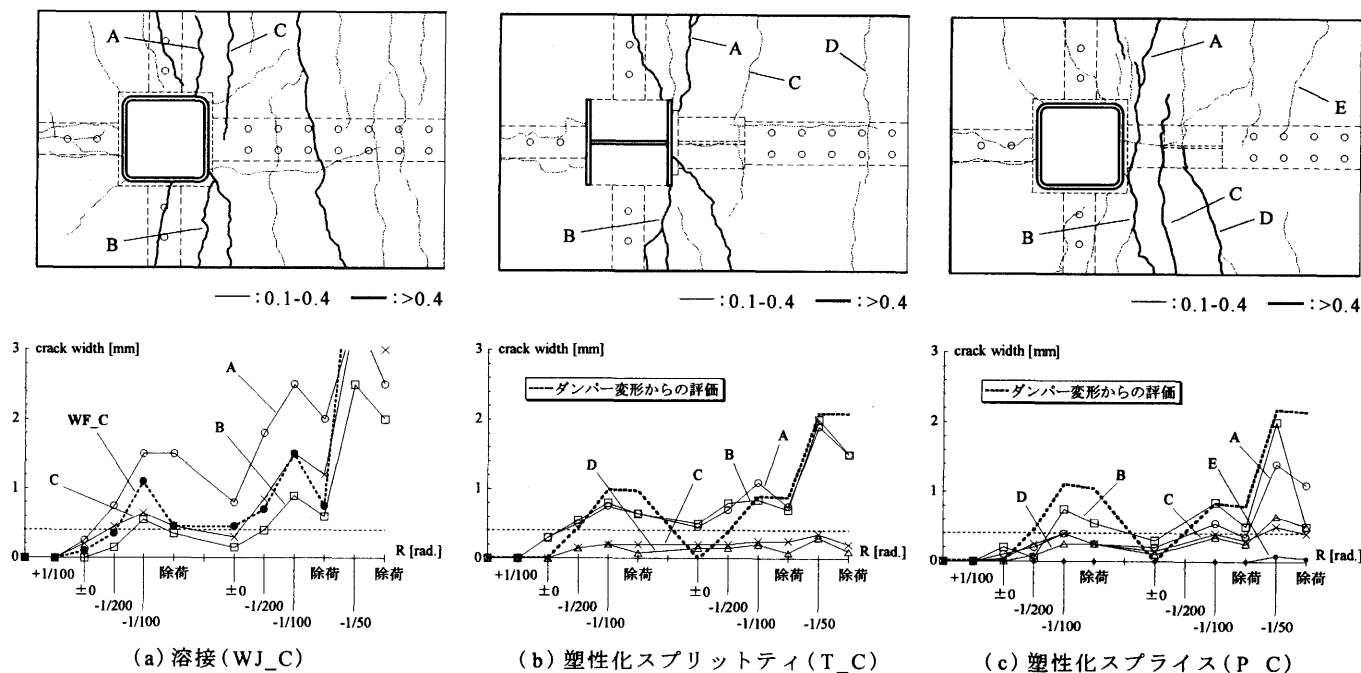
スラブのひび割れ発生状況(-1/50[rad.]到達時)とひび割れ幅の変動
